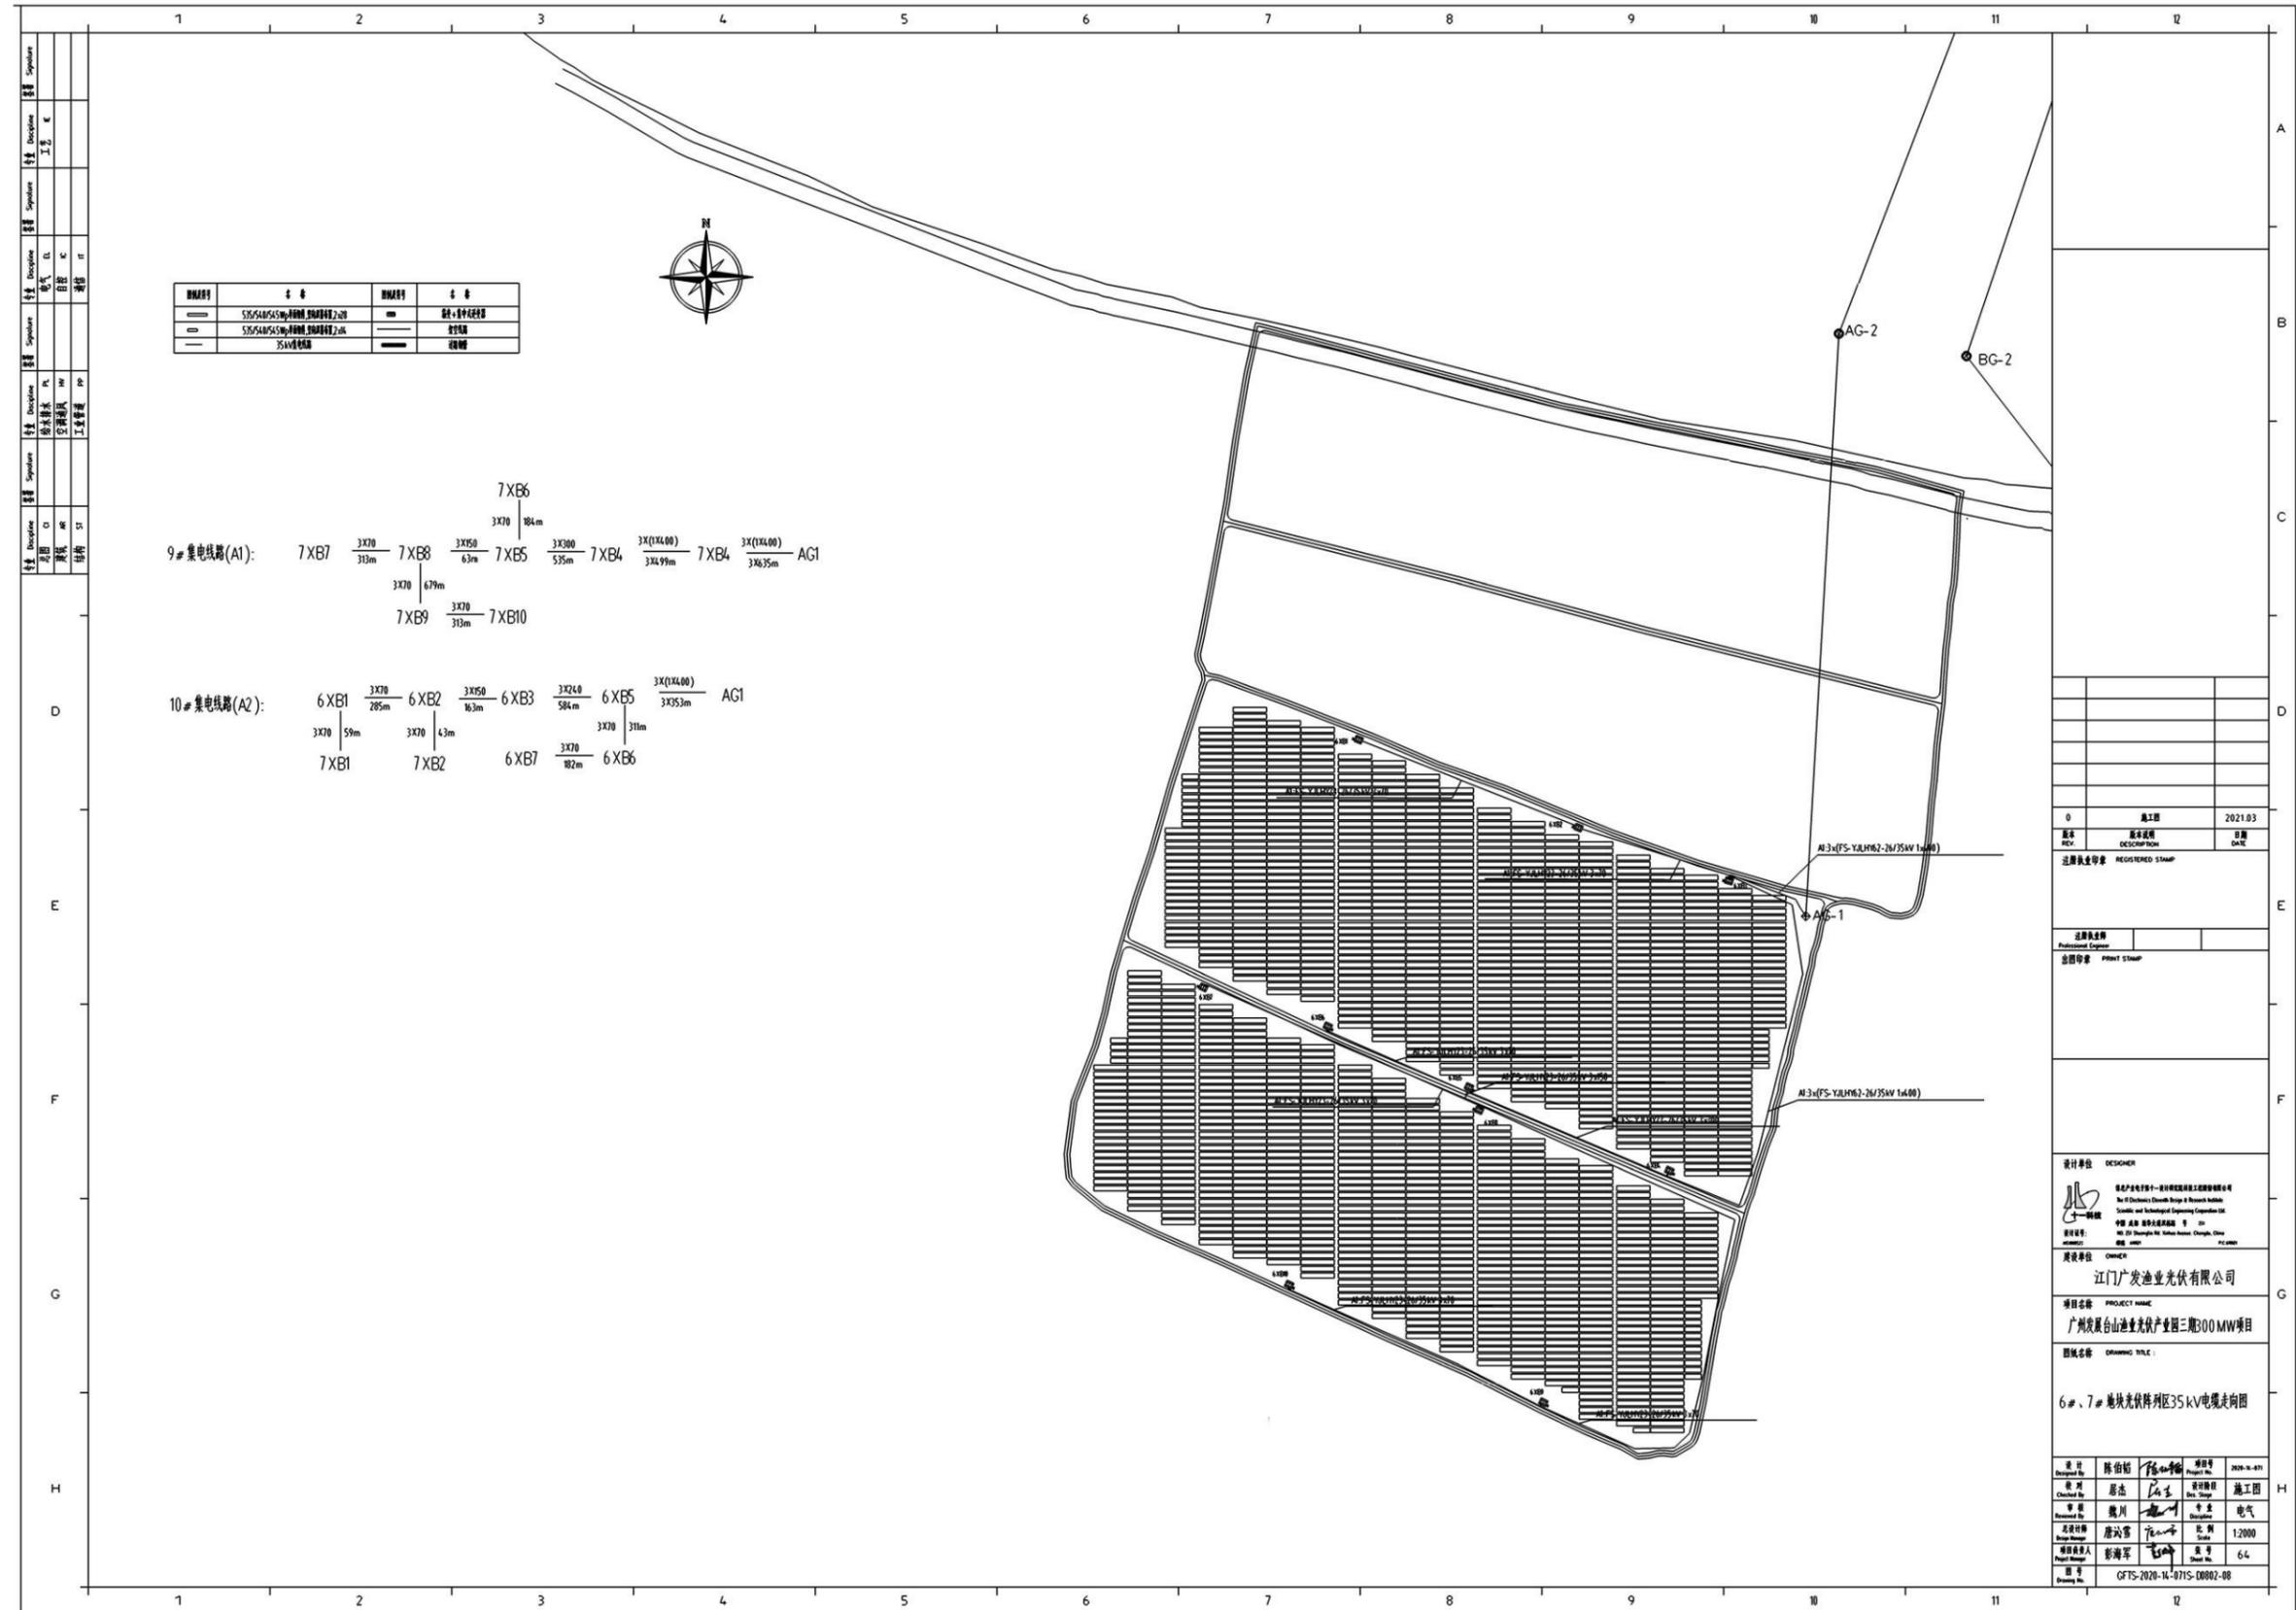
光伏区平面布置图 (A1-A2)
